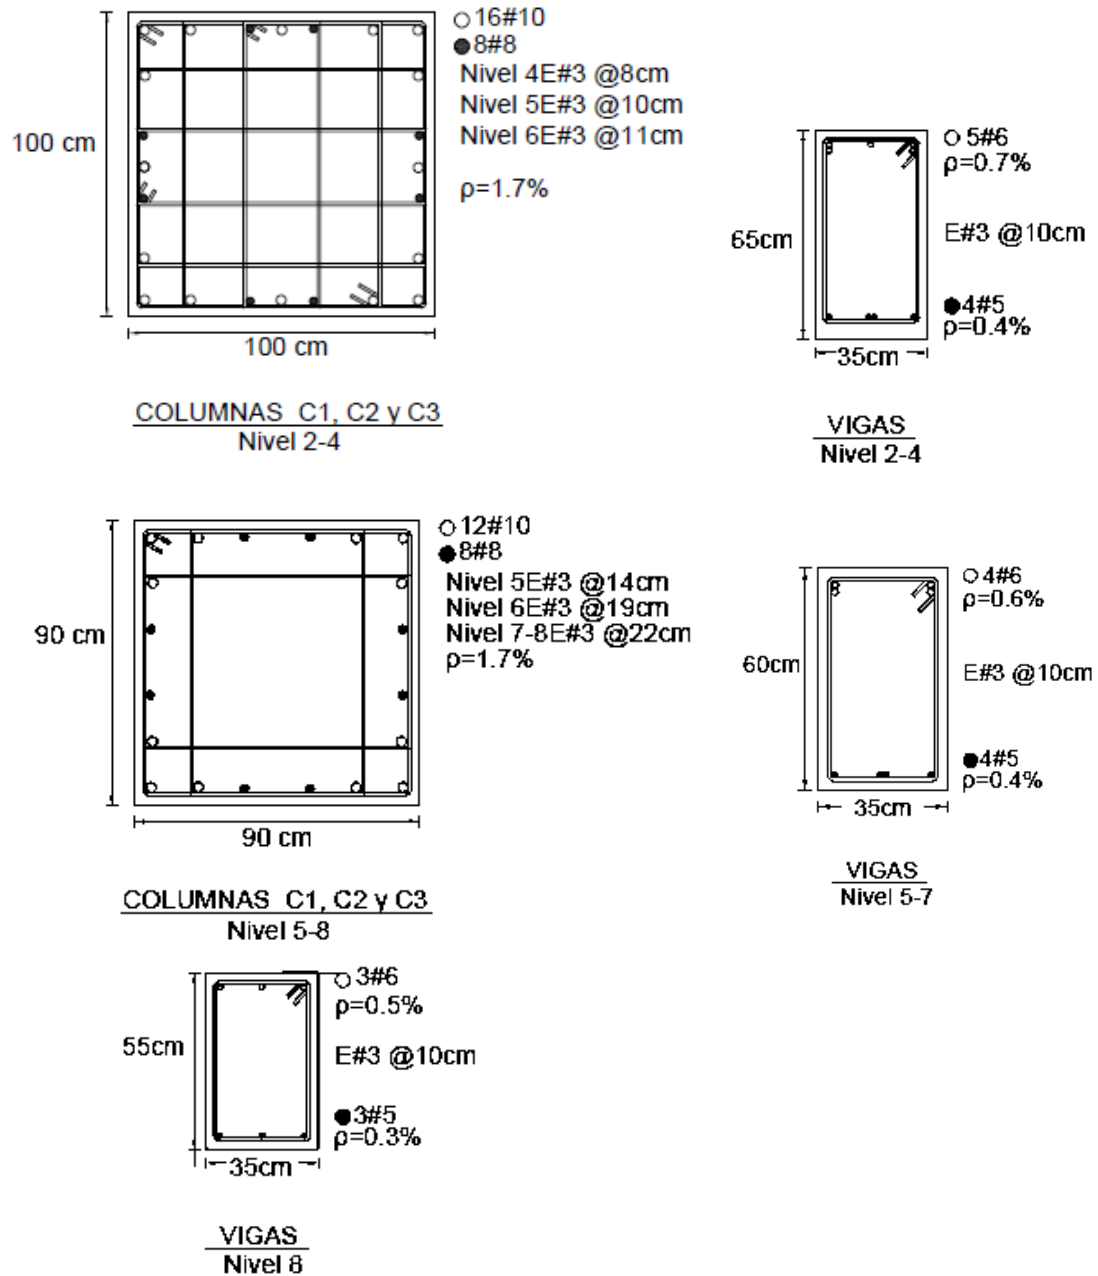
Armado de vigas y columnas diseñadas con las NTCC-17 para el edificio de 8 niveles cuyo sistema estructural consiste en marcos dúctiles y muros diafragma de mampostería no agrietada
